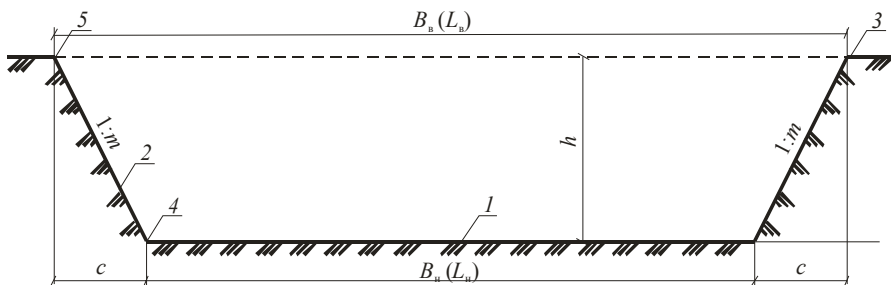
Элементы котлована: 1 – дно котлована; 2 – откос котлована; 3 – берма котлована; 4 – основание откоса; 5 – бровка котлована
